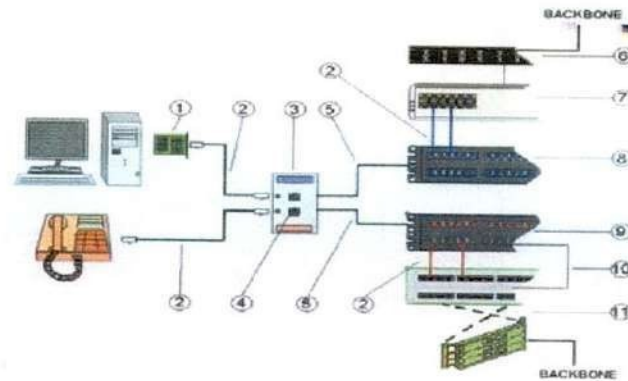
Esquema típico de conexión de un sistema de cableado estructurado
